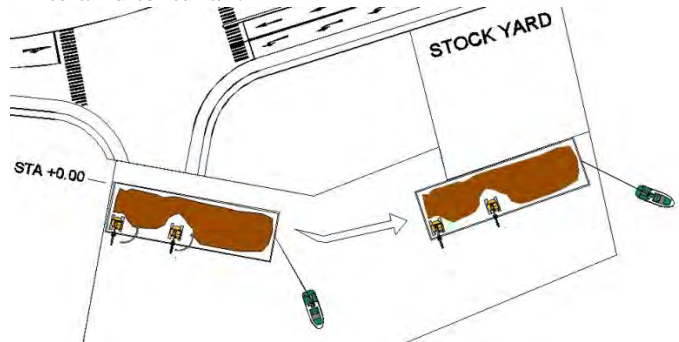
Potongan Memanjang rencana galian tanah menggunakan backhoe yang bekerja diatas ponton
